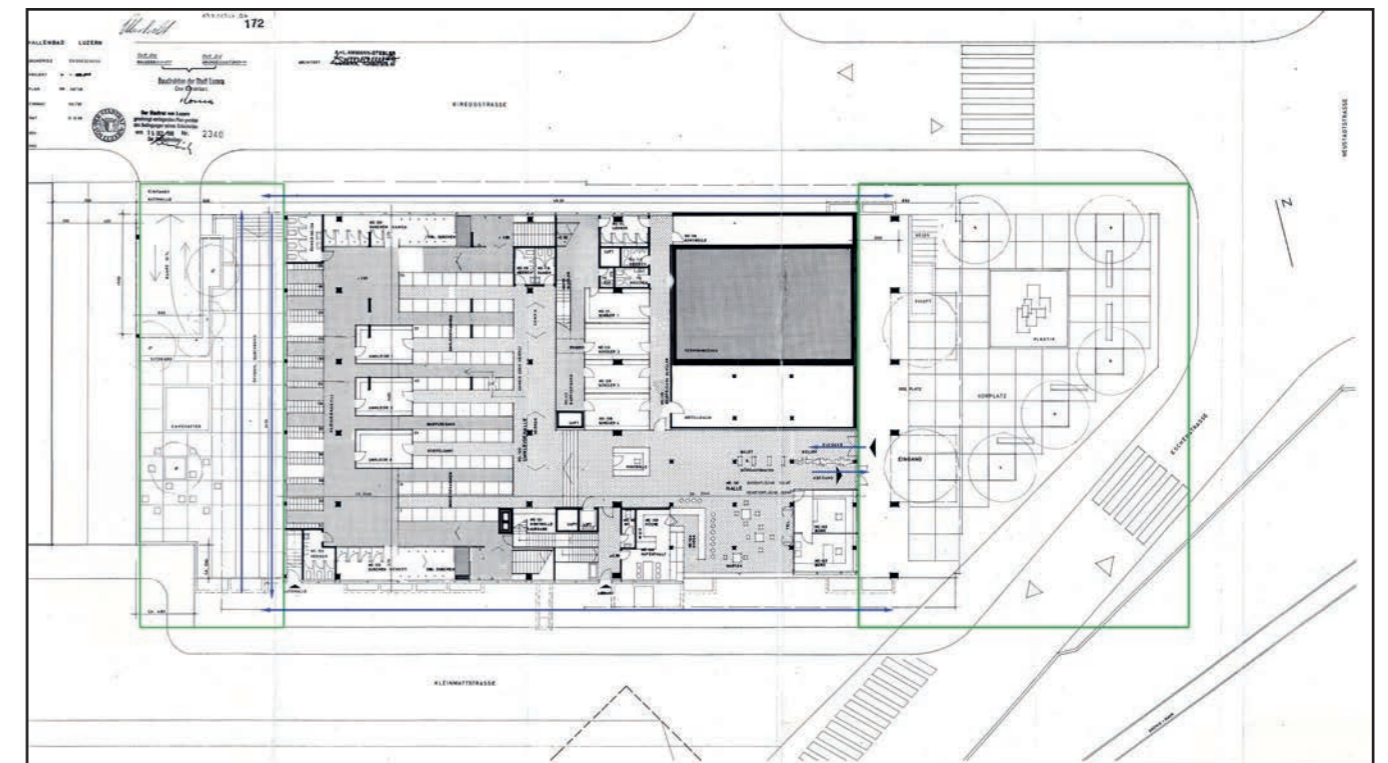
Grundriss Erdgeschoss Baueingabeplan 1966. Grün markiert die geplanten öffentlichen Räume vor und hinter dem Hallenbad. Blau markiert die öffentlichen Zu- und Durchgänge um und durch das Gebäude. Stadtarchiv Luzern, Bauakte Bireggstrasse 36.
